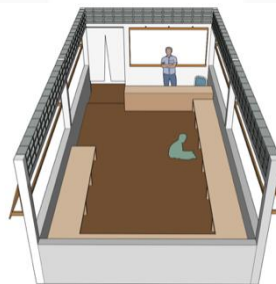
Penyelesaian Elemen Interior Ruang Kelas Tipe A
